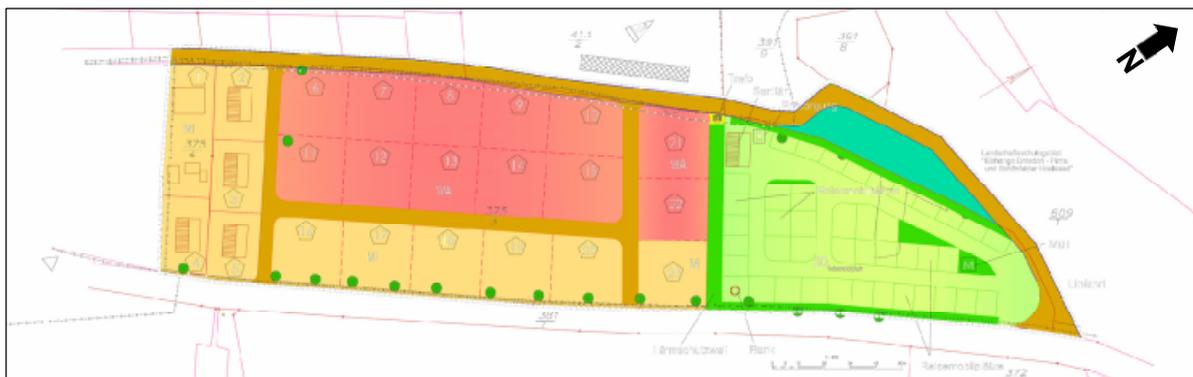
Lageplan des B-Plans Porschendorfer Weg, Gemeinde Lohmen, Variante 1 (mit Caravan-Stellplatz)
